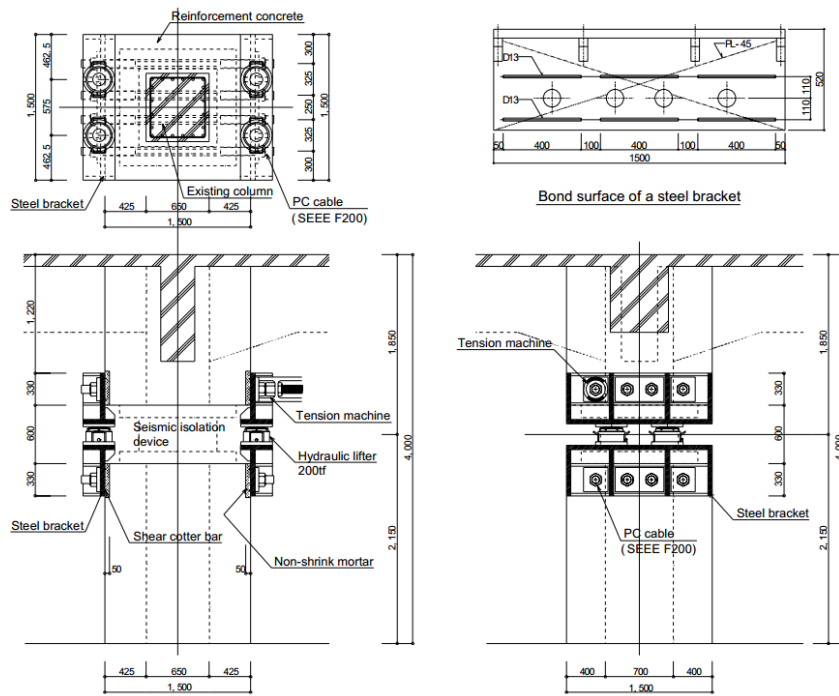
Detalle de la columna de Concreto Armado después del reforzamiento con “Jacketing” de columnas (Cardone,2014)
